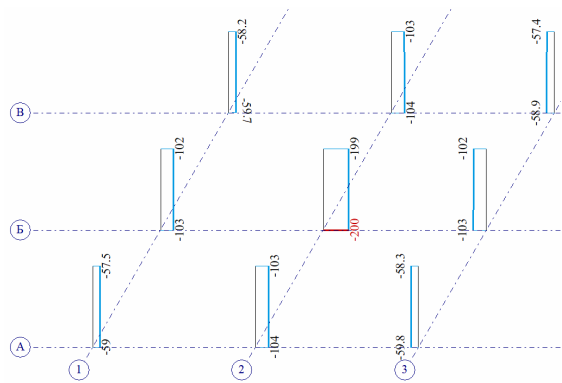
Повздовжні зусилля N в колонах першого поверху будівлі задачі №3.2, стадія №7, т
